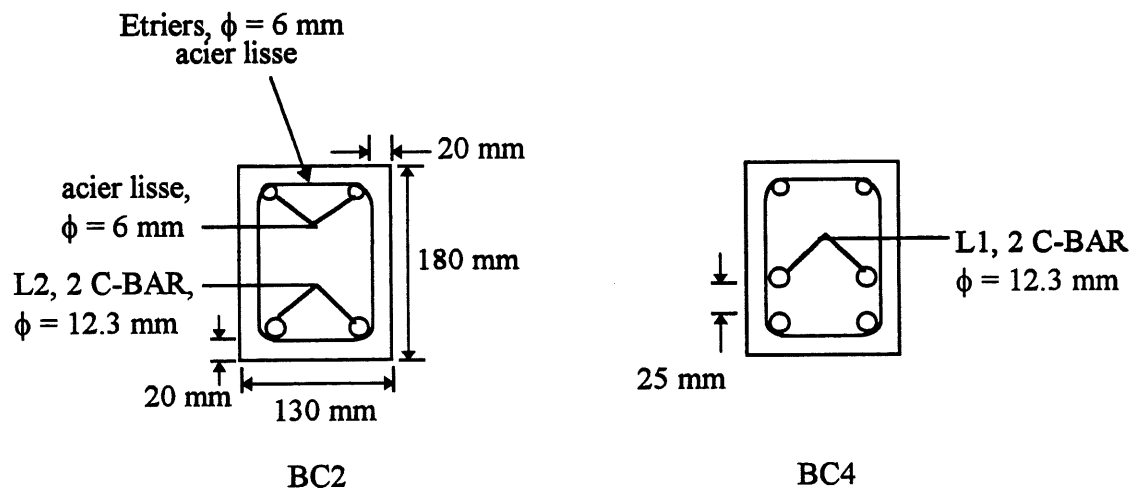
Détails de la disposition de l'armature des poutres BC
